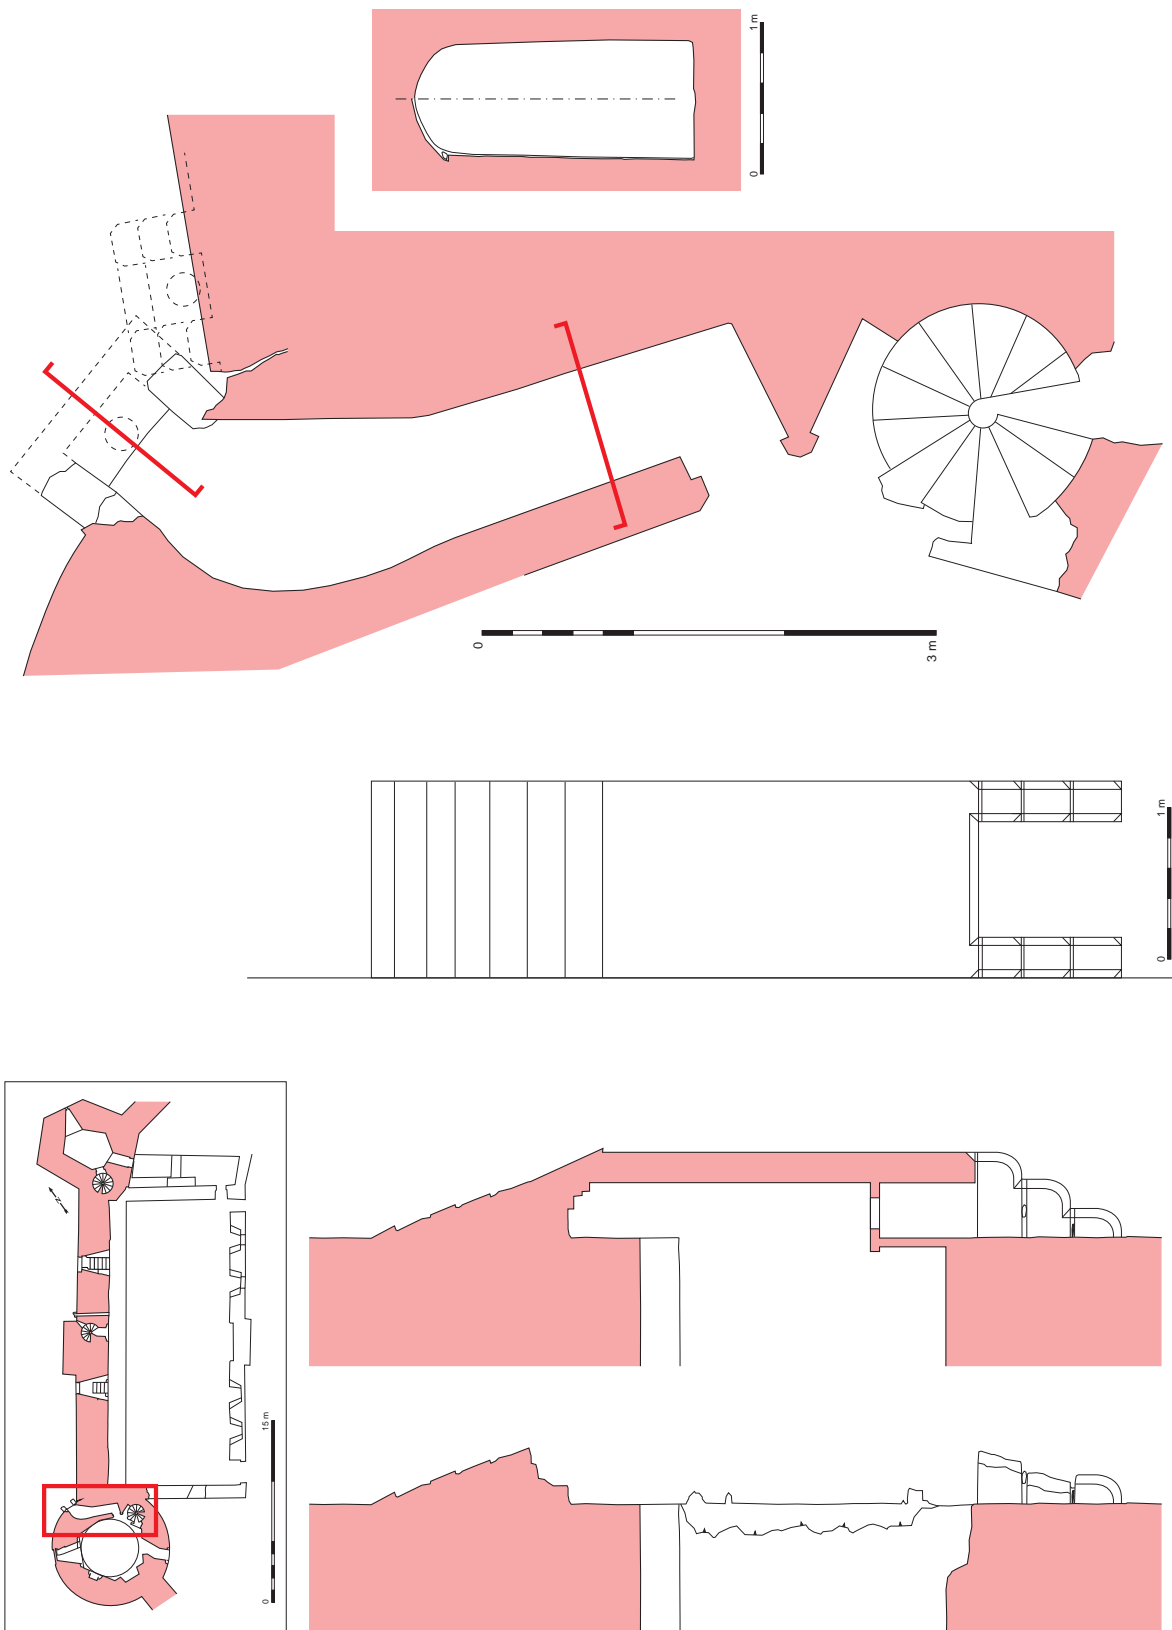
Plan, coupe des latrines du niveau 3 (premier étage) de la Grosse Tour (UE 1004) et proposition de restitution.
